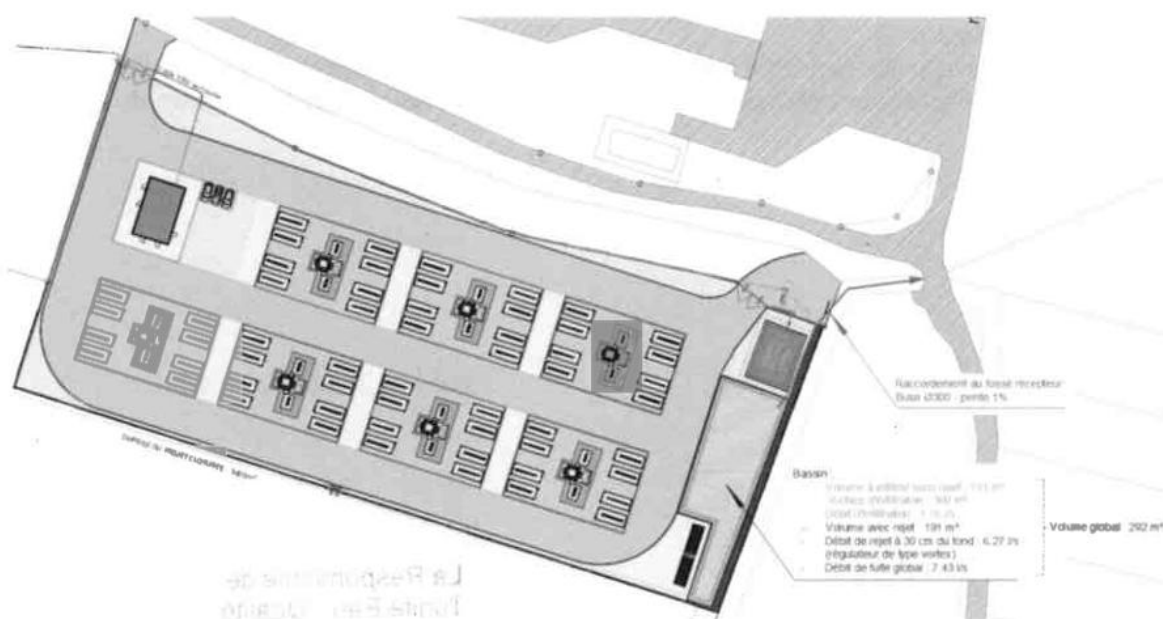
Vue en plan du dispositif de gestion des eaux pluviales
